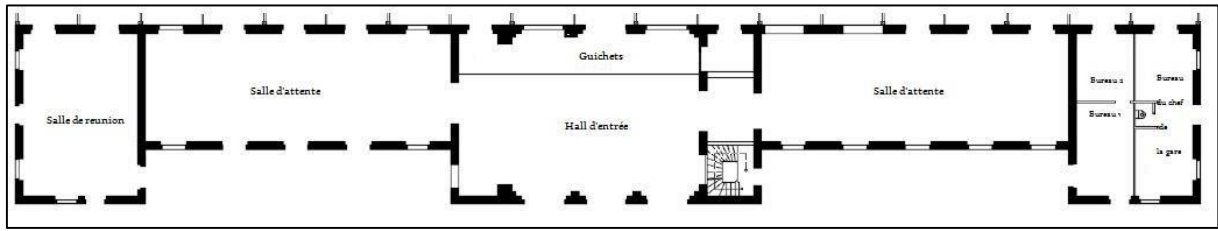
Plan du Rez de chaussée de la gare ferroviaire de Constantine
